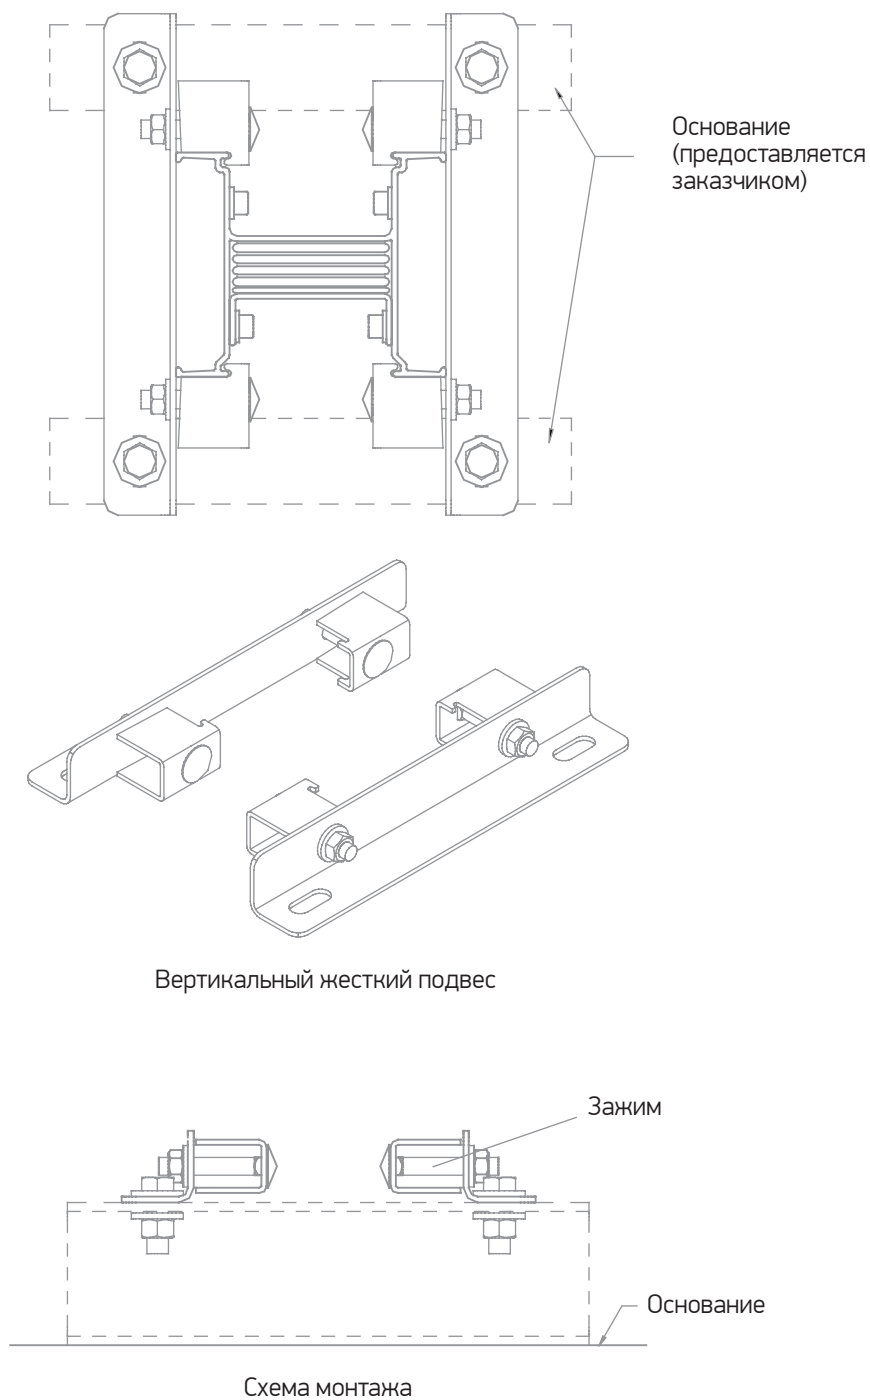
Монтаж с использованием вертикального жесткого подвеса
